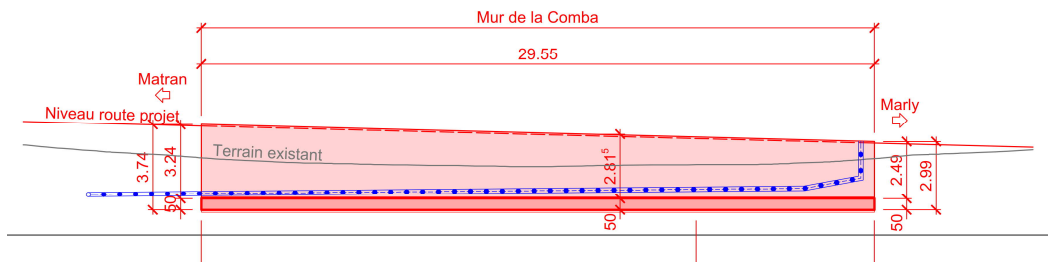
Elévation longitudinale du Mur de la Comba, km 2+992 à km 3+022
